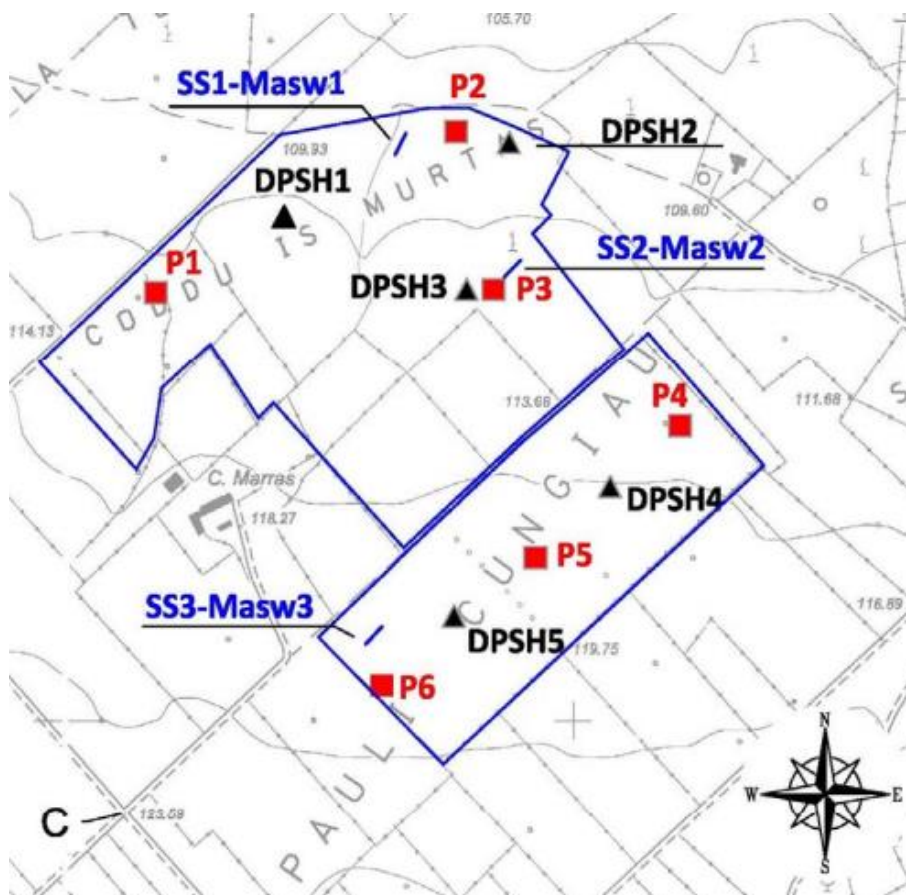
Planimetria con indicazione delle indagini geognostiche condotte in sito
